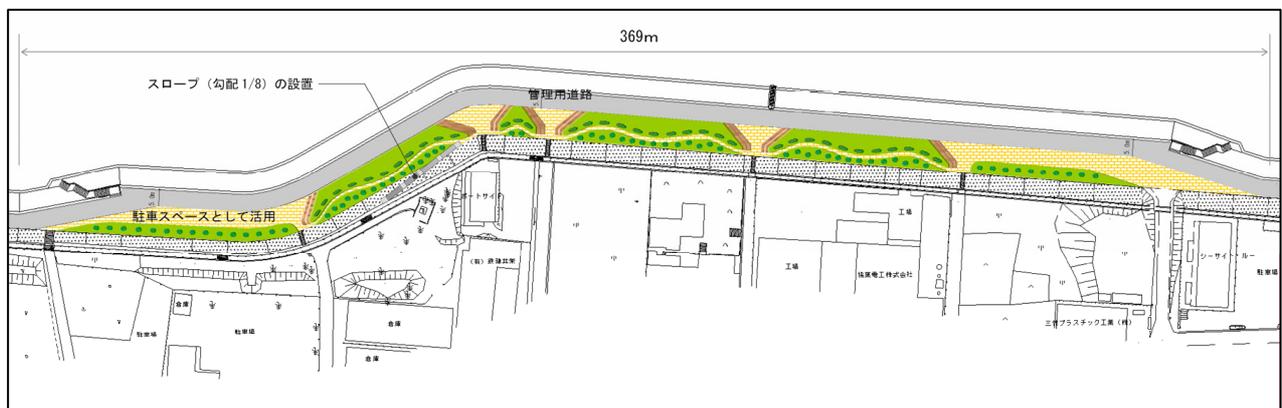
基本プランの検討を踏まえ作成したイメージ平面図
